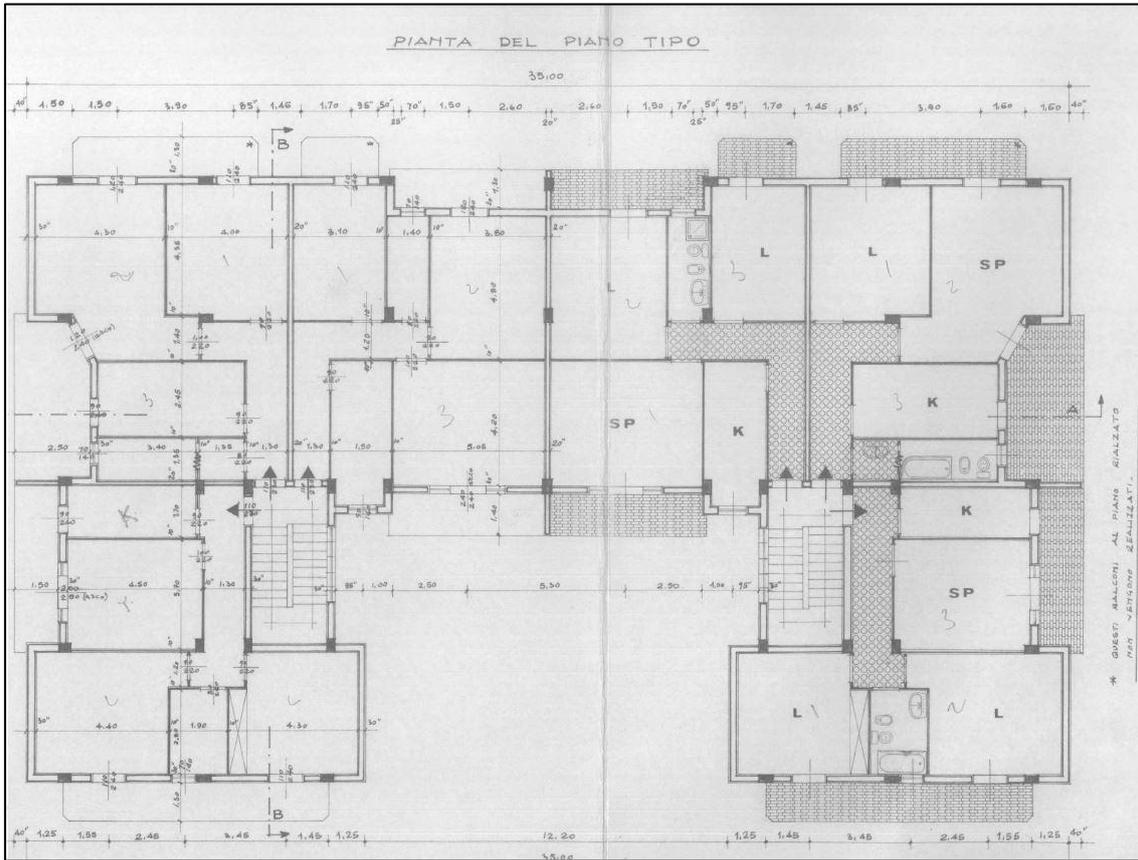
Pianta architettonica piano tipo edificio preso in esame
